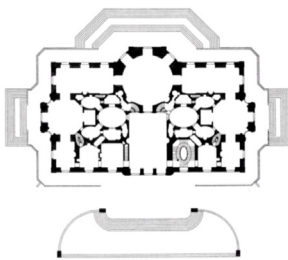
y 166. Plantas del proyecto: Planta inicial con estructura e instalaciones; Planta baja.
